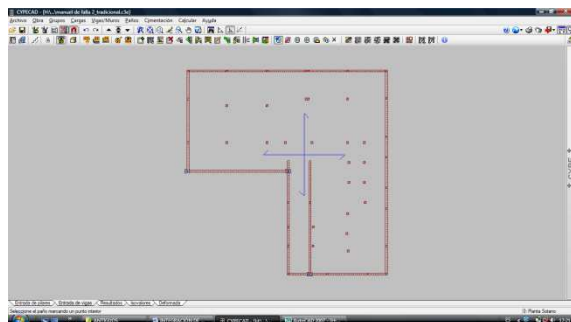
Resultado tras la introducción de la geometría de planta sótano (losa de cimentación y muros de sótano)
